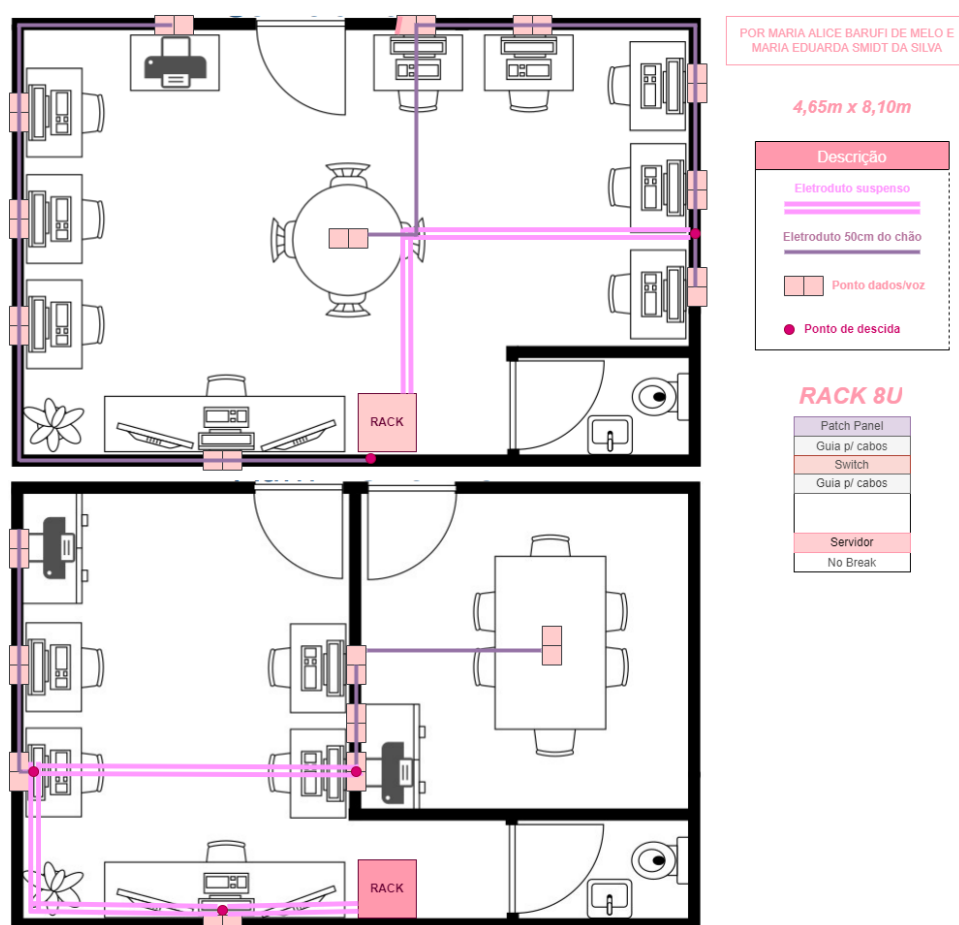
Planta baixa com distribuição dos pontos de rede no modelo de Projeto de Rede Estruturado. Fonte: Das próprias autoras.
